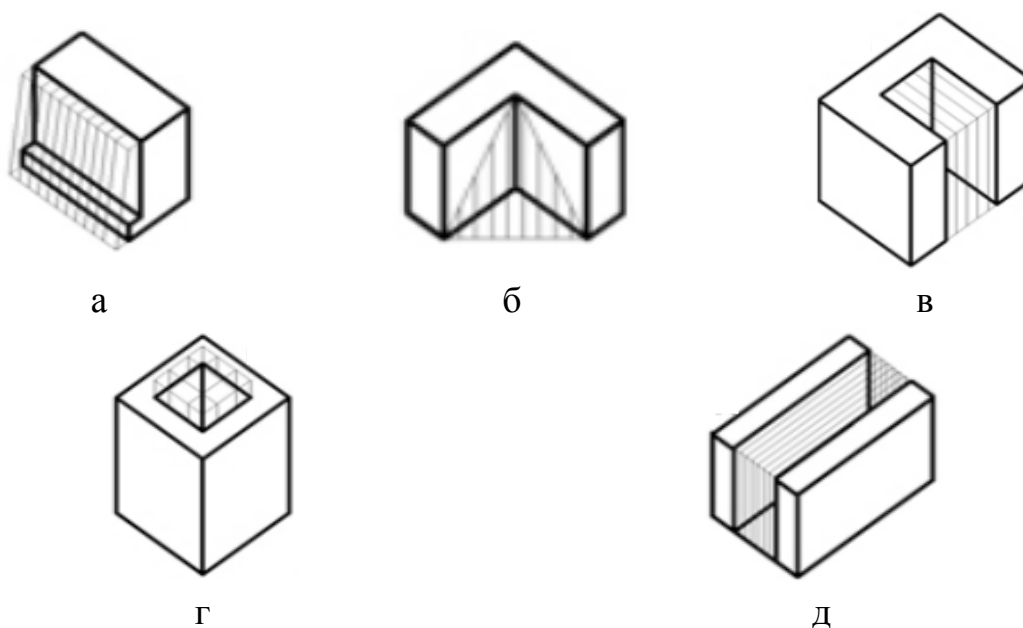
Типы конструкций атриумов: а – оранжерейный; б – двухстенный; в – трехстенный; г – четырехстенный; д – линейный
